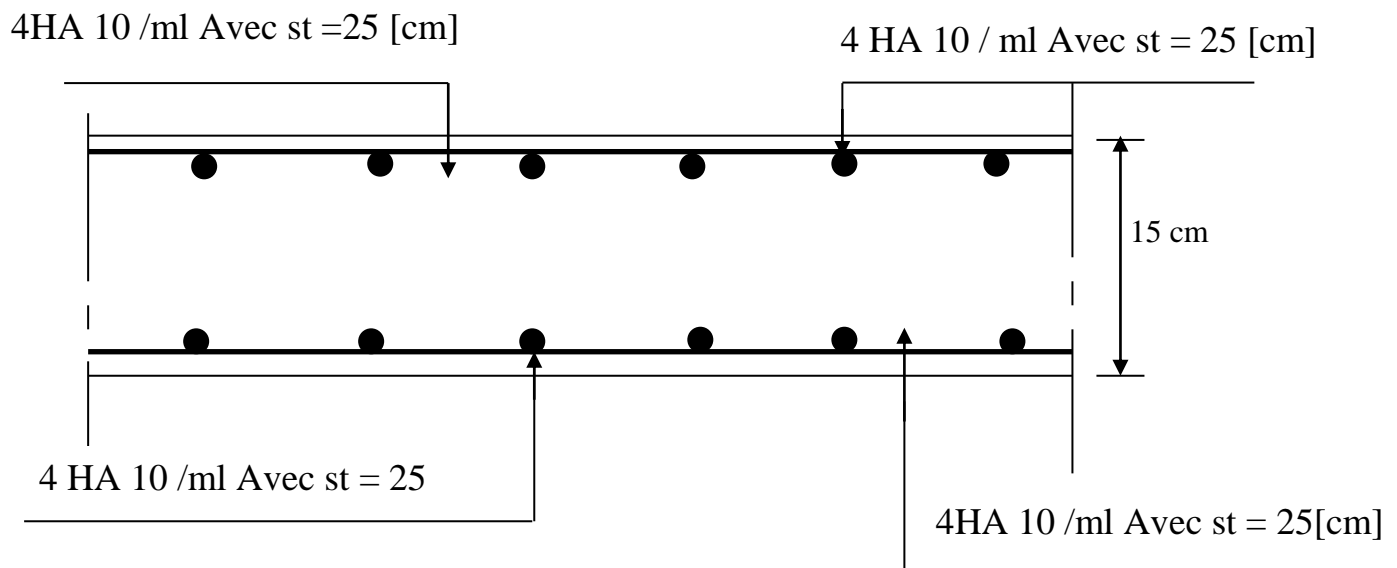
Ferraillage de la dalle dans le sens X-X
